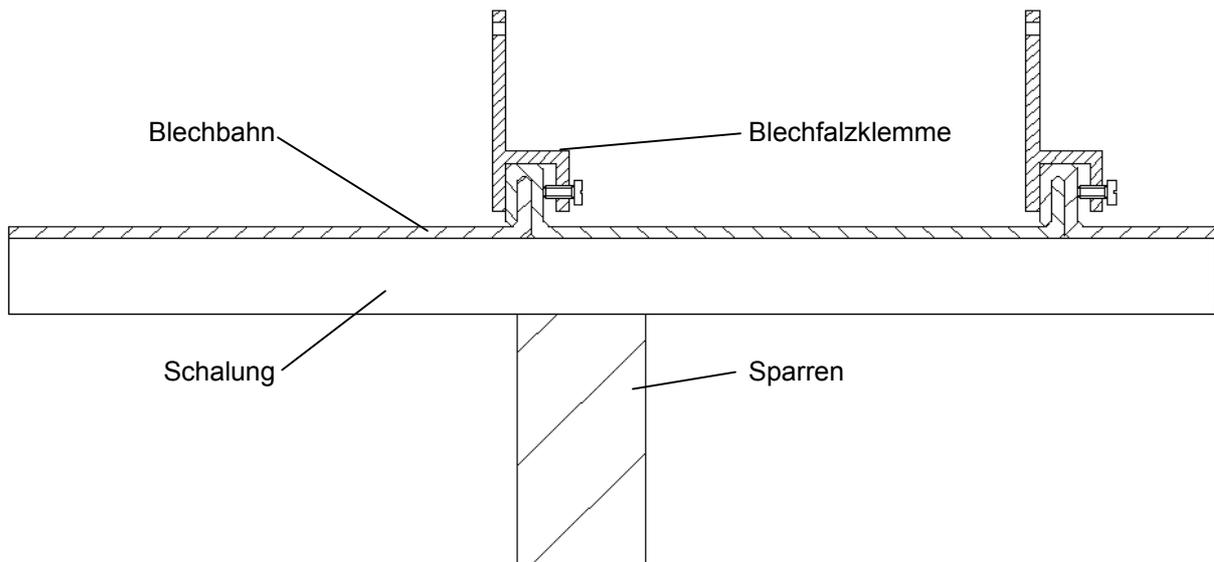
Prinzipzeichnung einer Blechfalzklemme
